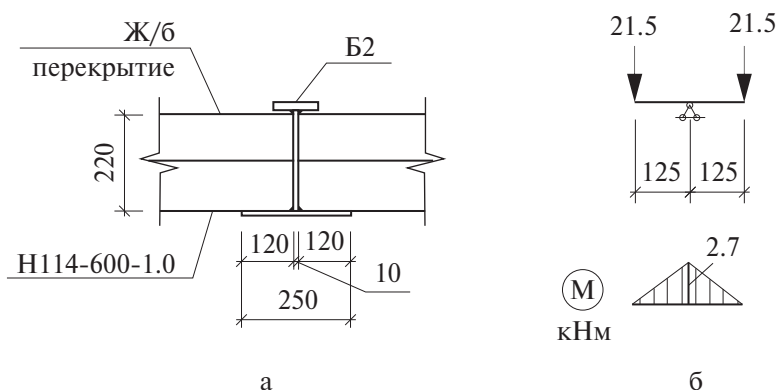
Схема опирания (а) и расчетная схема (б) балки с уширенной нижней полкой
